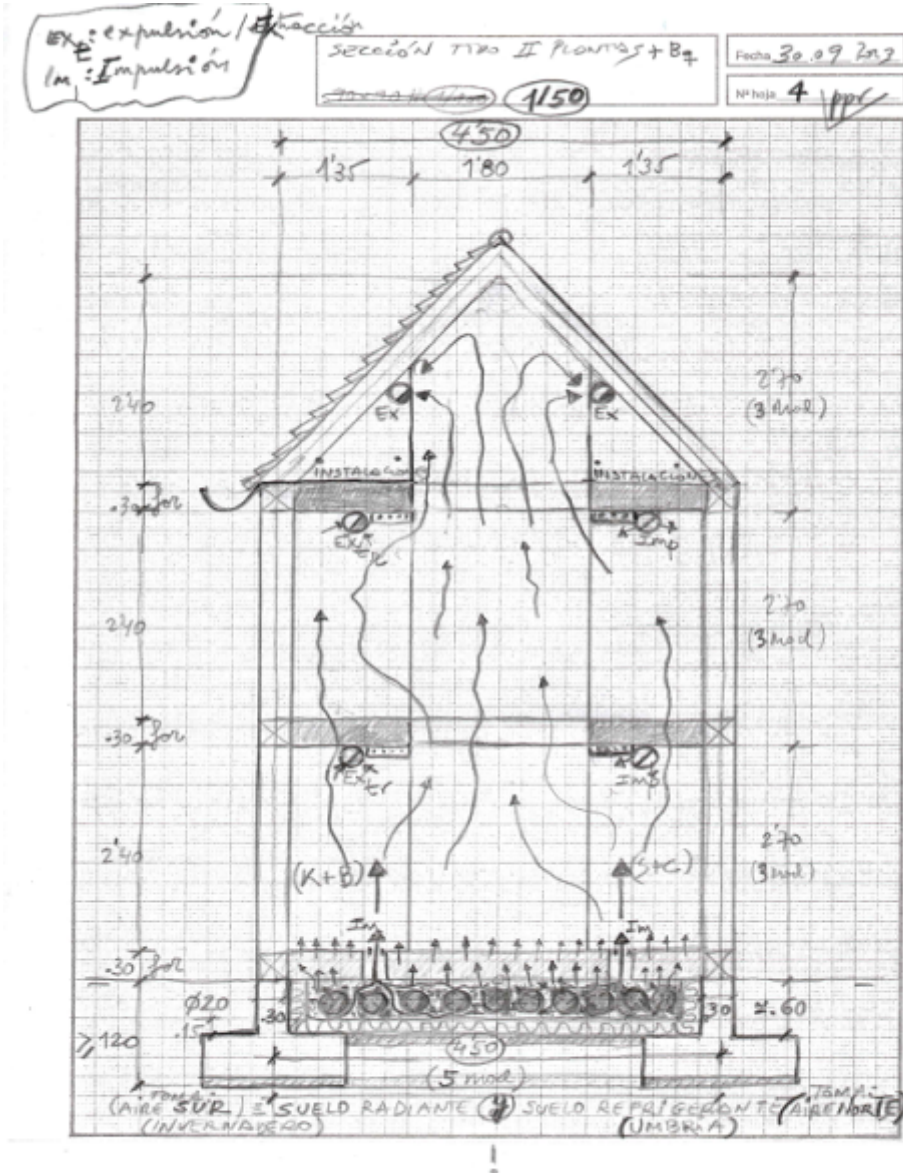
/ 3: Croquis previos de sección acotadas del prototipo (no seleccionado) desarrollado en dos plantas y bajo cubierta.
